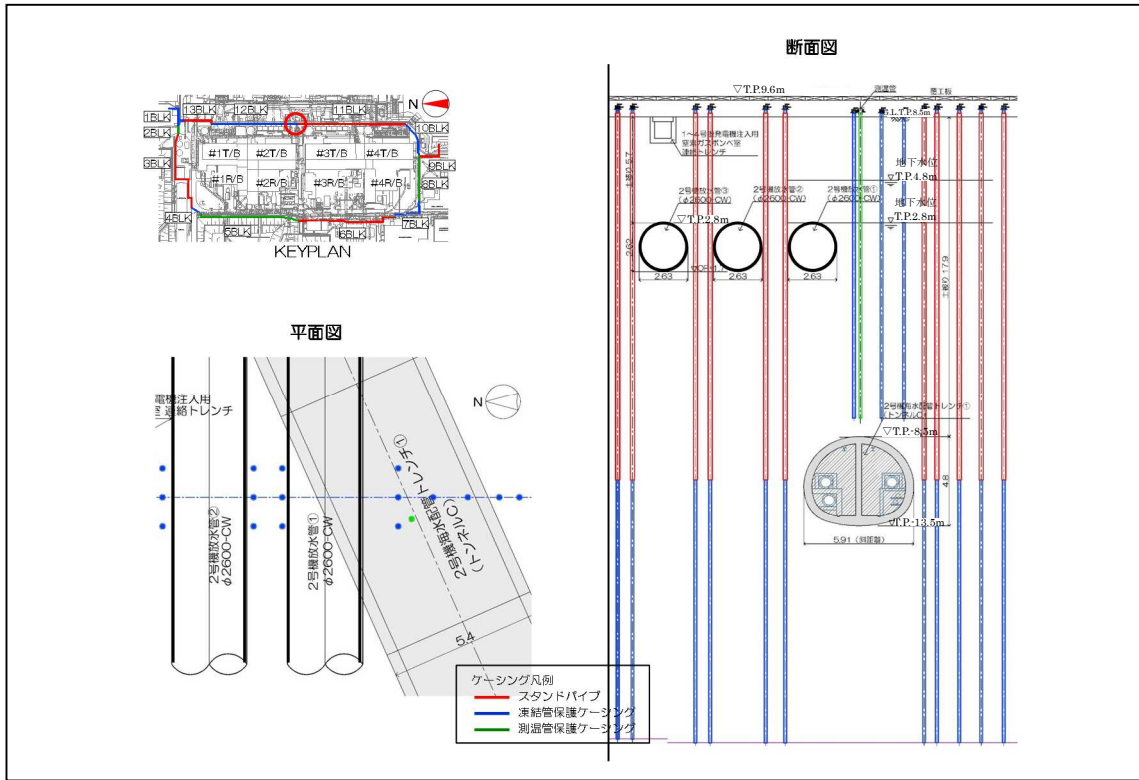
2号機海水配管トレンチトンネルC部 施工平面図・断面図
